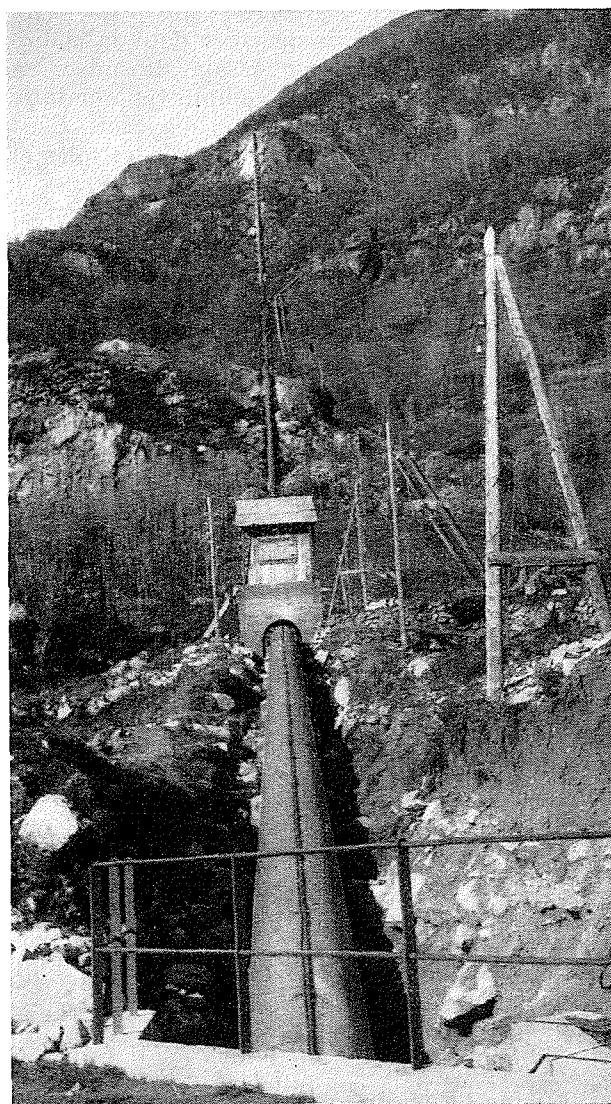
Vue de la troisième conduite (on aperçoit sur la droite les deux premières).
